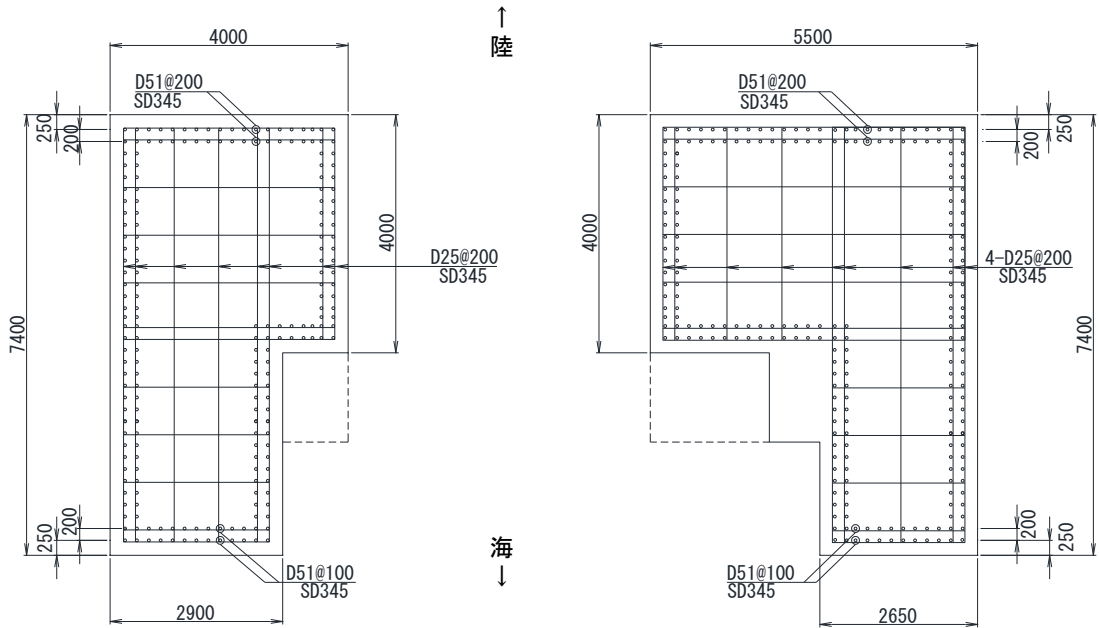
漂流物対策工戸当り (RC支柱) の概略配筋図 (A-A 断面)
